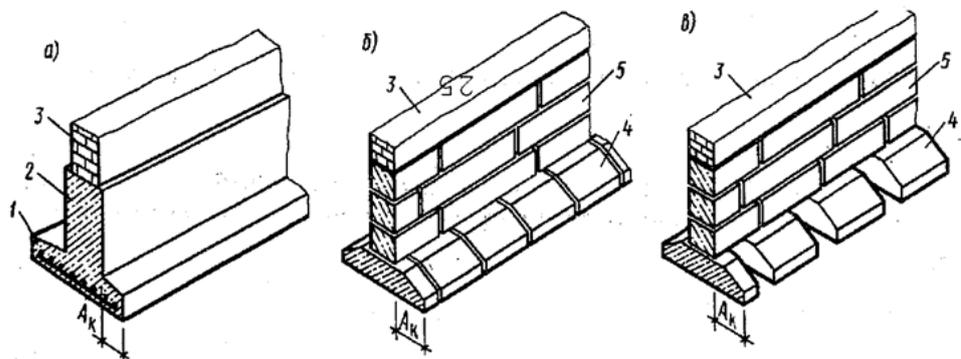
Ленточные фундаменты: а – монолитный; б – сборный сплошной; в – сборный прерывистый; 1 – армированная лента; 2 – фундаментная стена; 3 – стена здания; 4 – фундаментная подушка; 5 – стеновой блок
